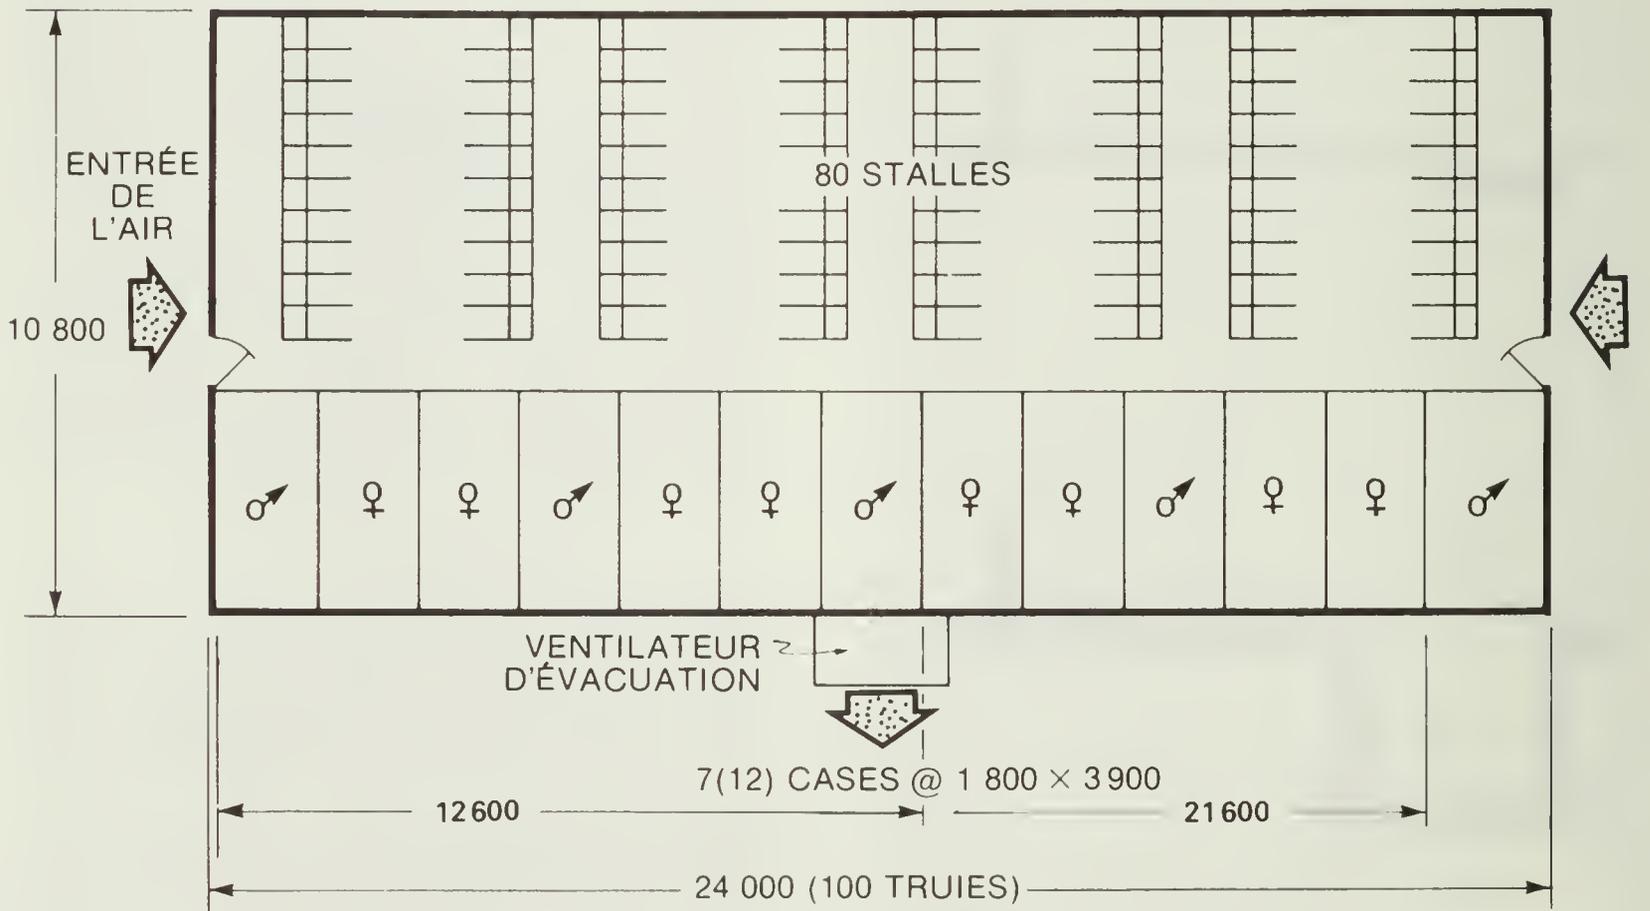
Plan d'une section d'accouplement et de gestation avec stalles ou cases à entraves pour truies, et cases pour jeunes truies ou verrats
